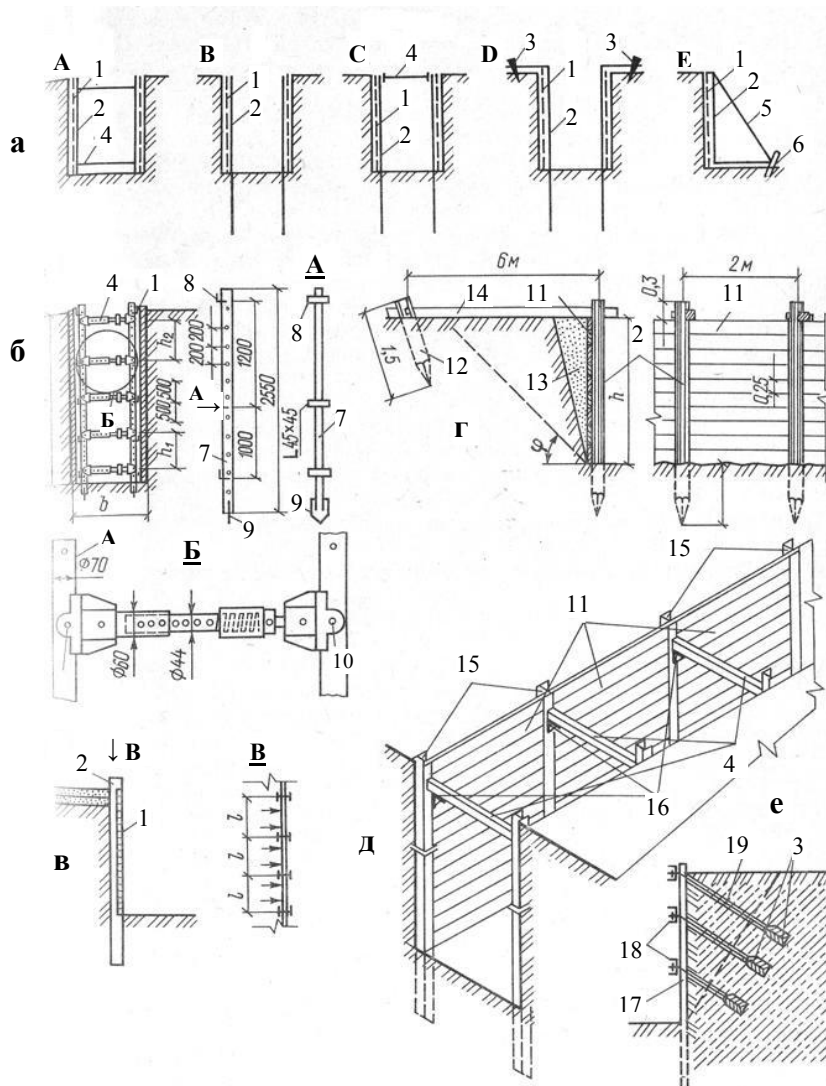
Способи укріплення стінок виїмок: а – схеми конструктивних рішень; б – укріплення інвентарне розпірне; в – консольний тип; г – консольно-анкерний тип; д – консольно-розпірний тип; е – огороження шпунтове з внутрішнім анкерним кріпленням; А – розпірне; В – консольне; С – консольно-розпірне; D – консольно-анкерне; Е – підкосне; 1 – щит; 2 – стояк (паля); 3 – анкер; 4 – розпірка; 5 – підкіс; 6 – упертя; 7 – стояк металевий; 8 – куточок; 9 – загострення; 10 – болт; 11 – закидка; 12 – паля-анкер; 13 – засипання; 14 – тяж; 15 – балка (двотаврв); 16 – куточки сталінні підтримуючі; 17 – стінка шпунтова; 18 – балка (швелер); 19 – тяга
